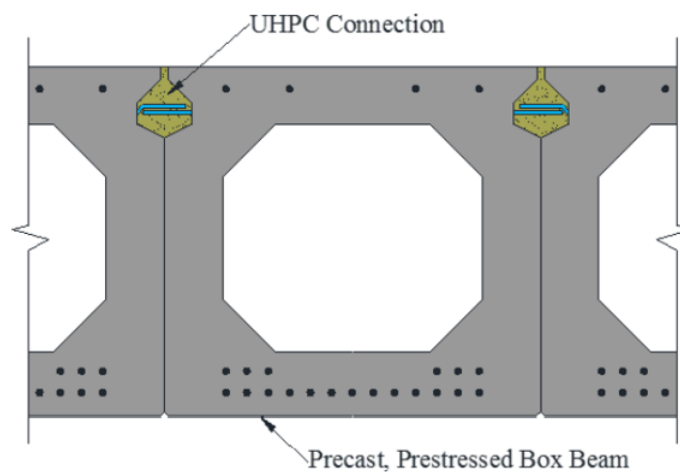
Ligações realizadas com UHPFRC entre vigas pré-fabricadas e pré-esforçadas adjacentes [28].
